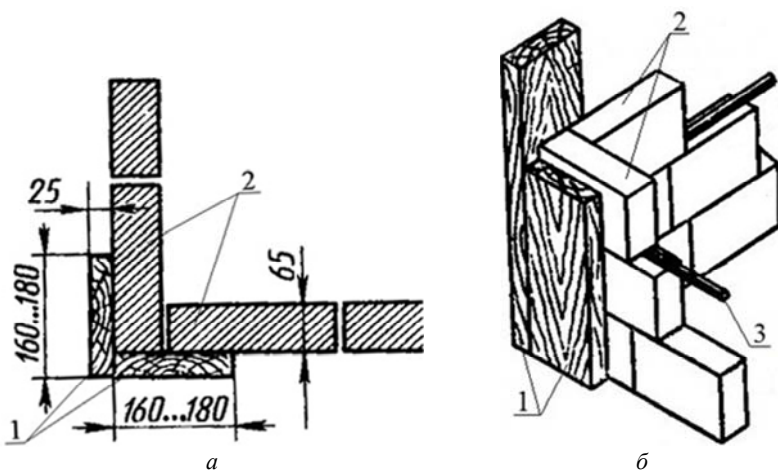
Кладка перегородок с шаблоном из досок:
